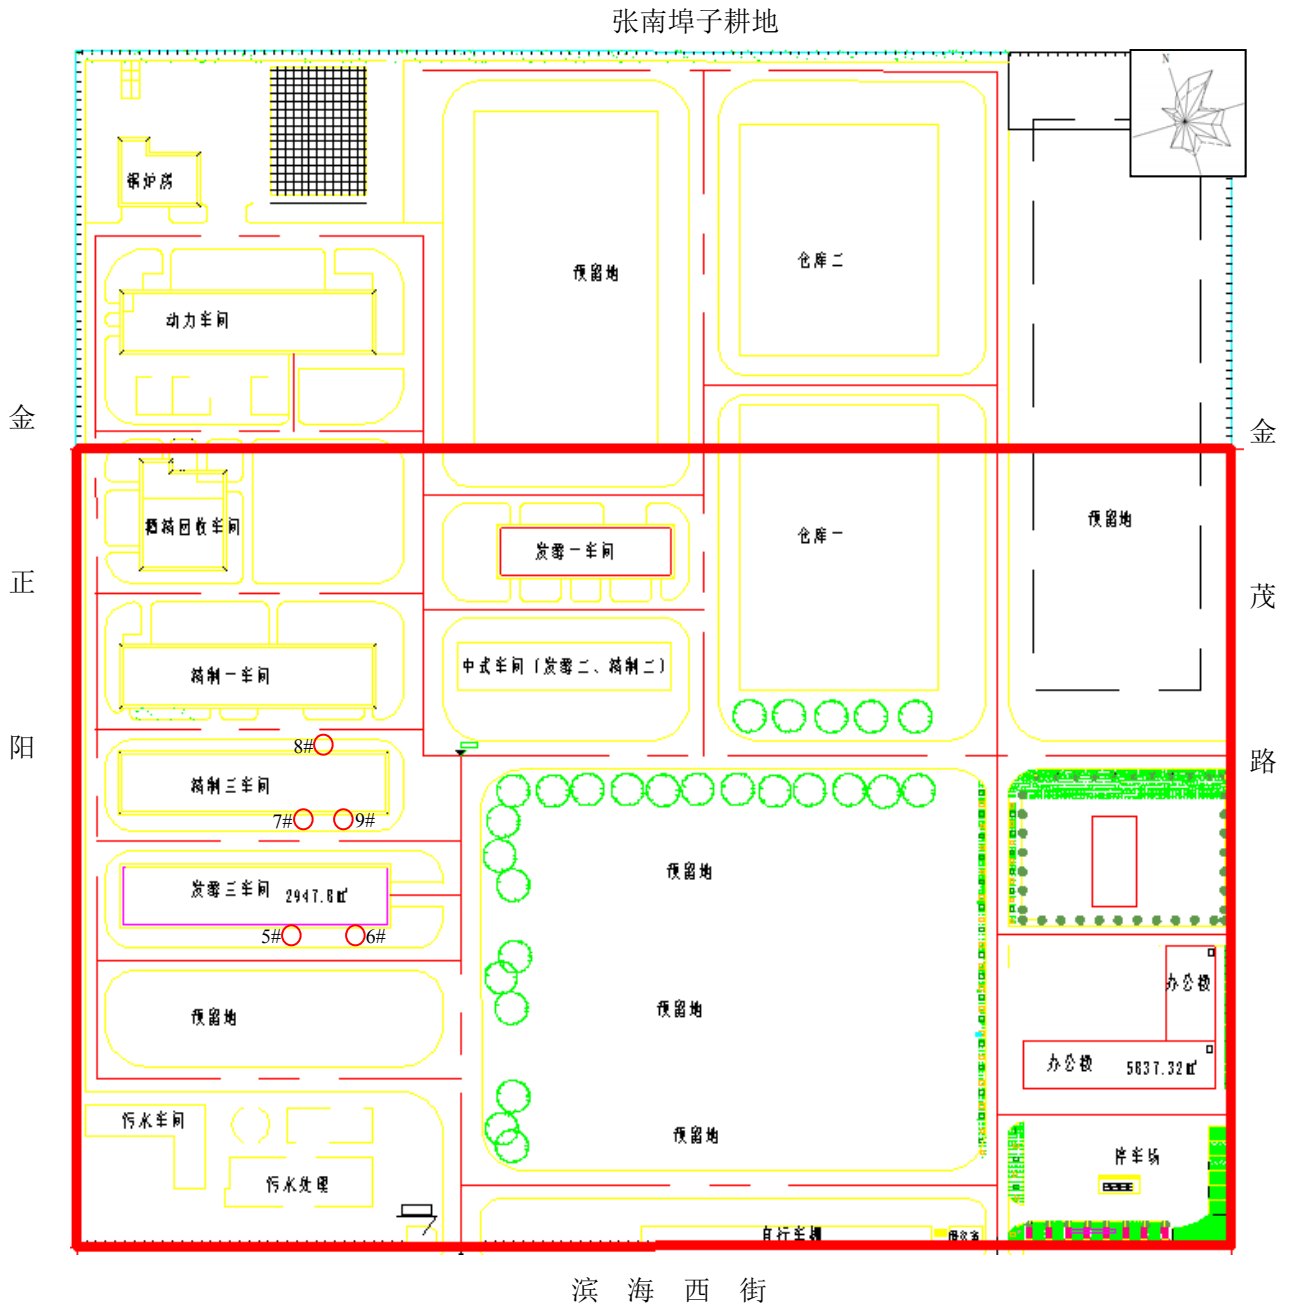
项目平面布置图 (“○”为排气筒的位置)
